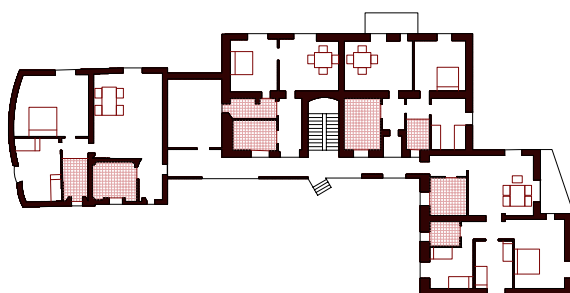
Planta tipo Complexo Residencial “Tiburtino”
